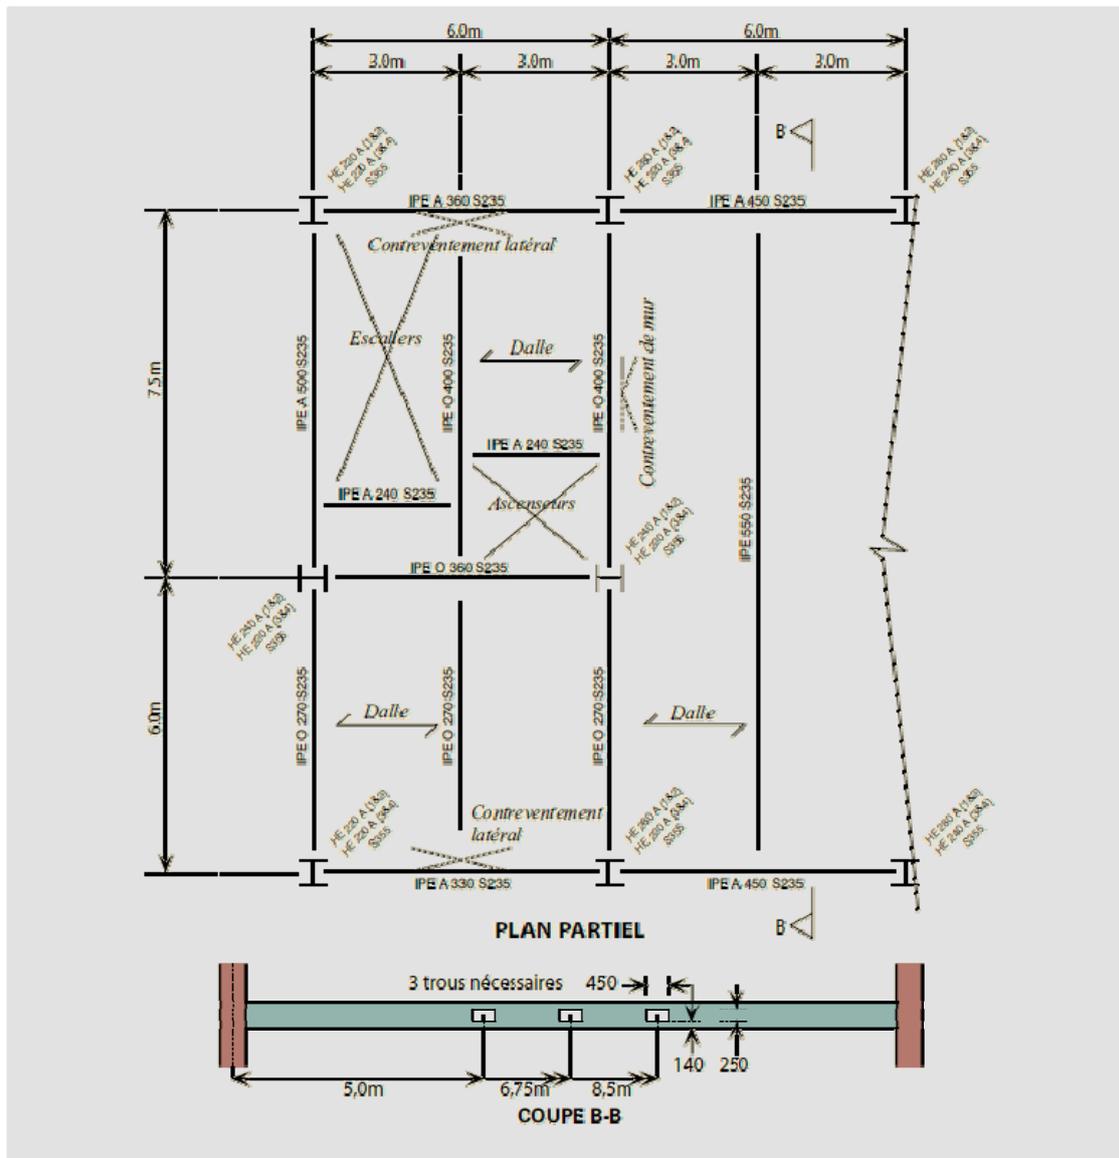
Poutres mixtes de grande portée (à ouvertures rectangulaires dans l'âme)
